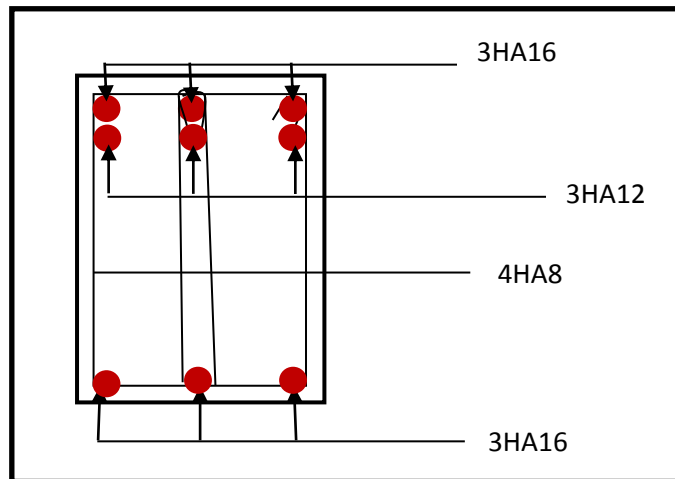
Ferrailage aux appuis d'une poutre secondaire
